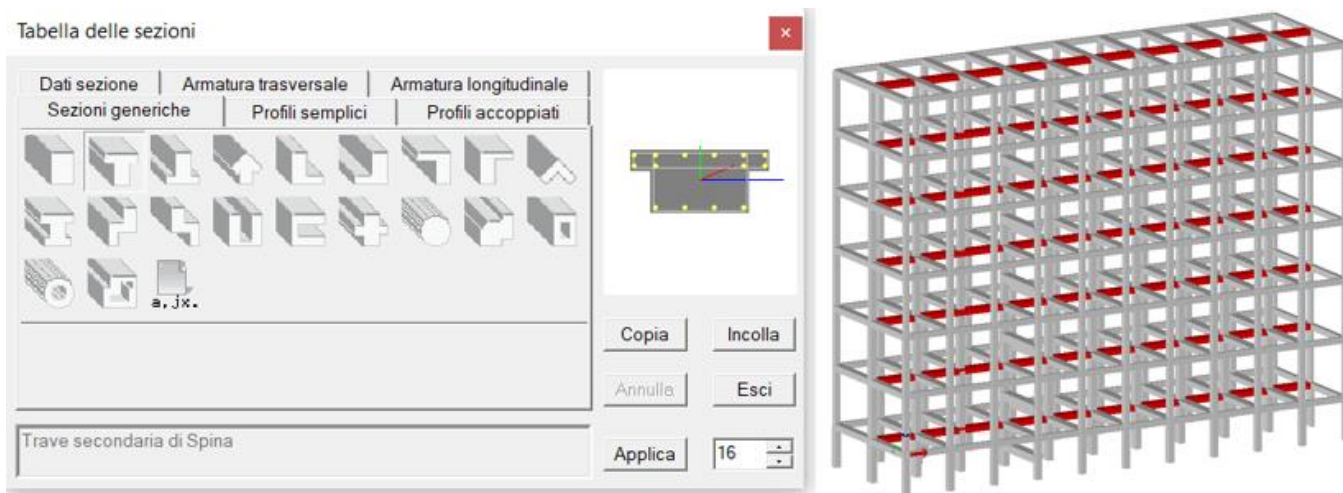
Modello US B1 - PROSAP, Archivio Sezioni, Proprietà n° 15 Trave Secondaria di spina, con inquadramento.
